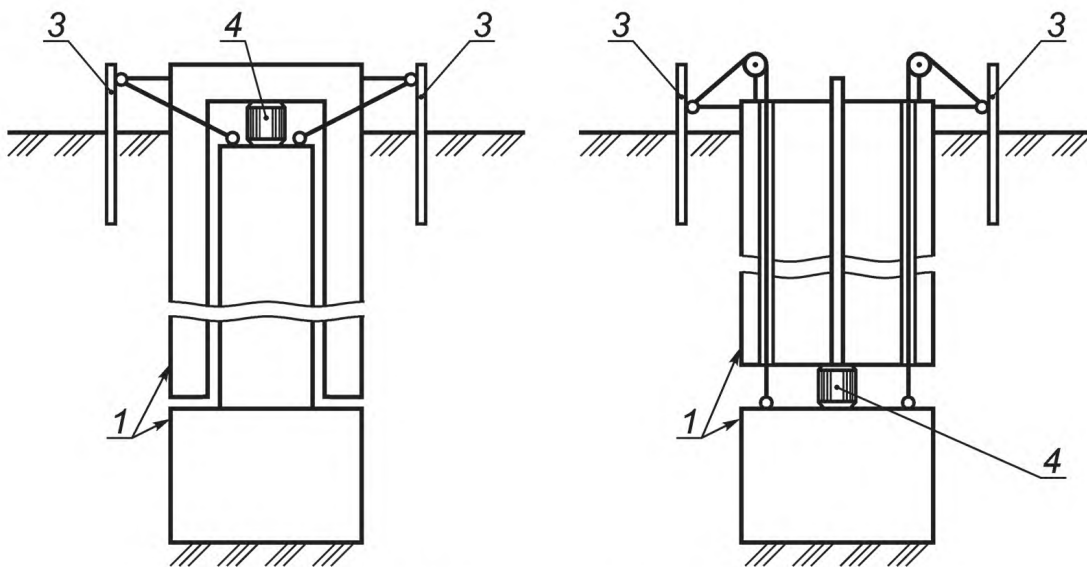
Схемы установок для испытаний грунтов сваями, лист 1
